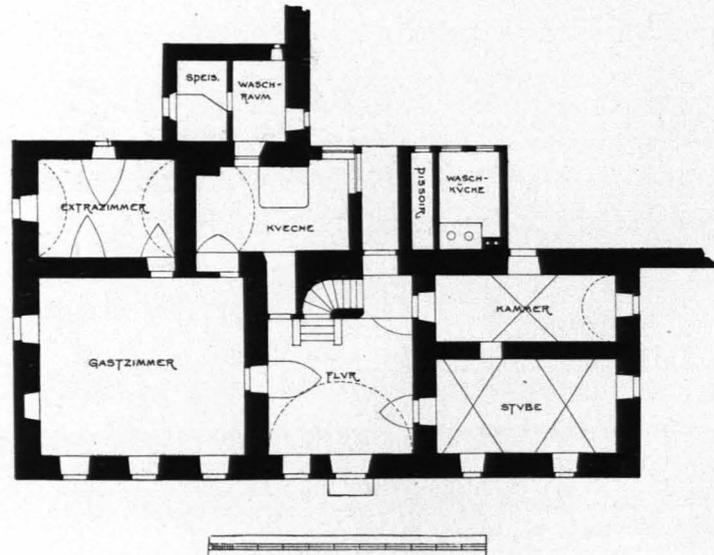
Zwettl, Artnershof, Grundriß 1 : 300 (S. 469)
